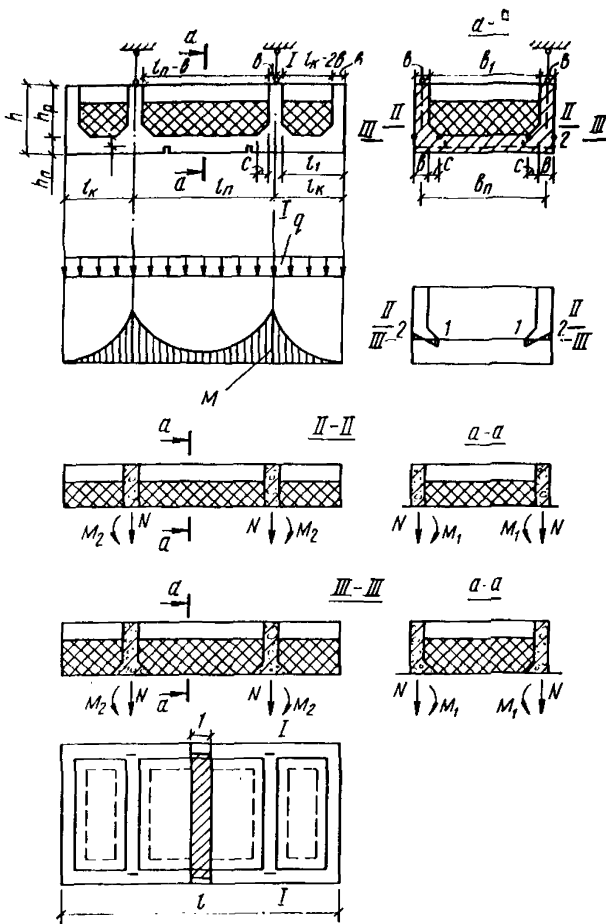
Расчетная схема определения усилий в подвесной ребристой панели от собственного веса
